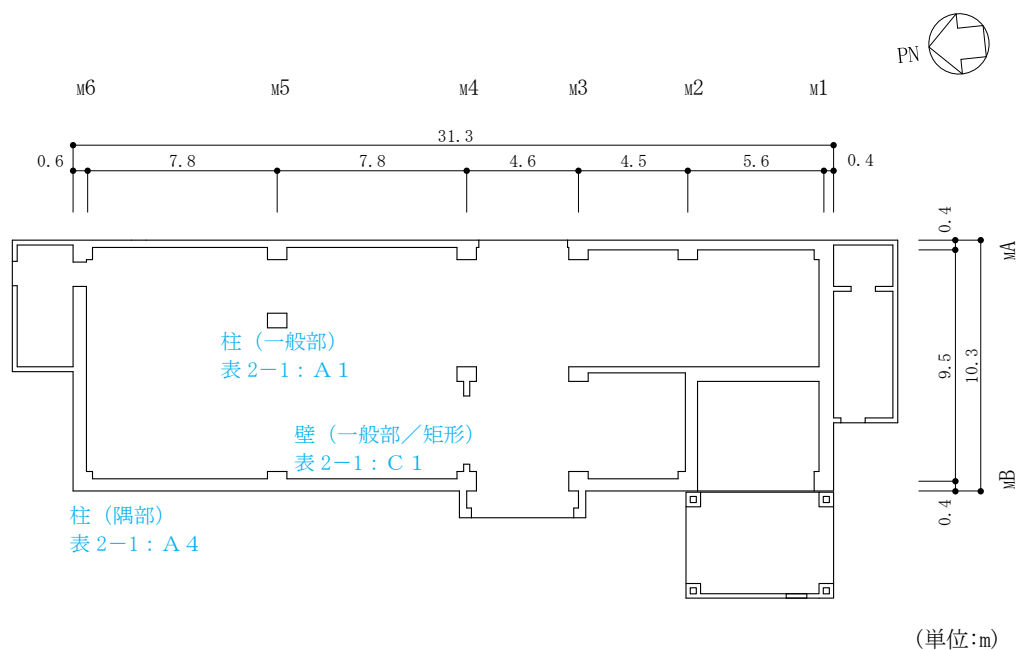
サイトバンカ建物（増築部）の概略平面図（EL 8.8m）
